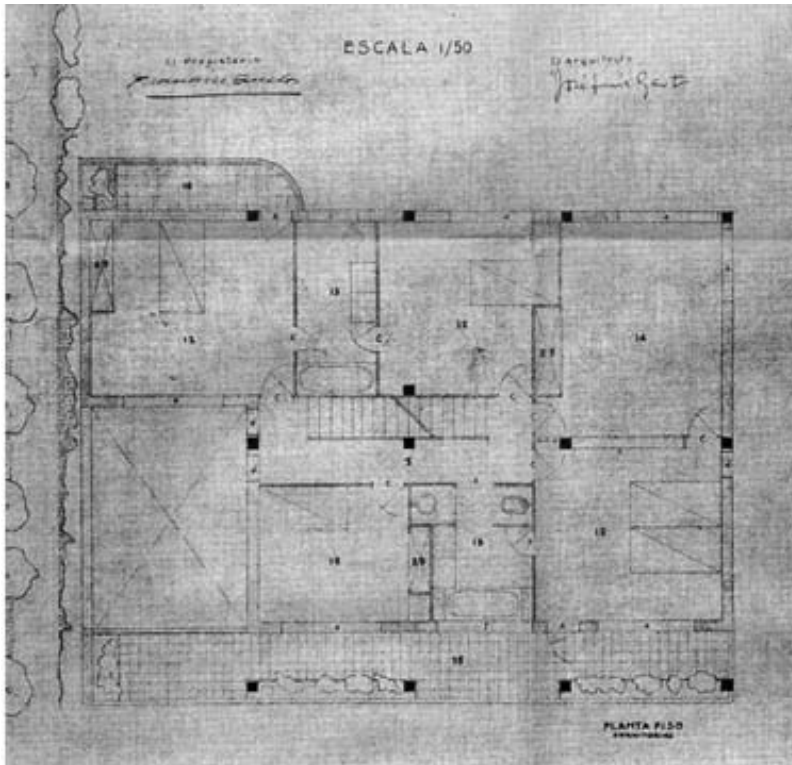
Planta primera Casa Duclós. Nótese la distribución de pilares y la ejecución del cerramiento oeste con muro de carga, lugar donde se sitúa la habitación principal (LOUSAME, 2011:802)
